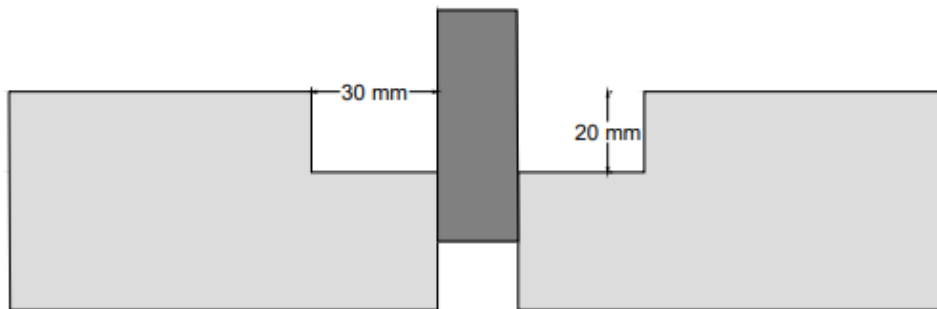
Sellado de Fisuras y Grietas, Silicona de bajo módulo, corte transversal.
